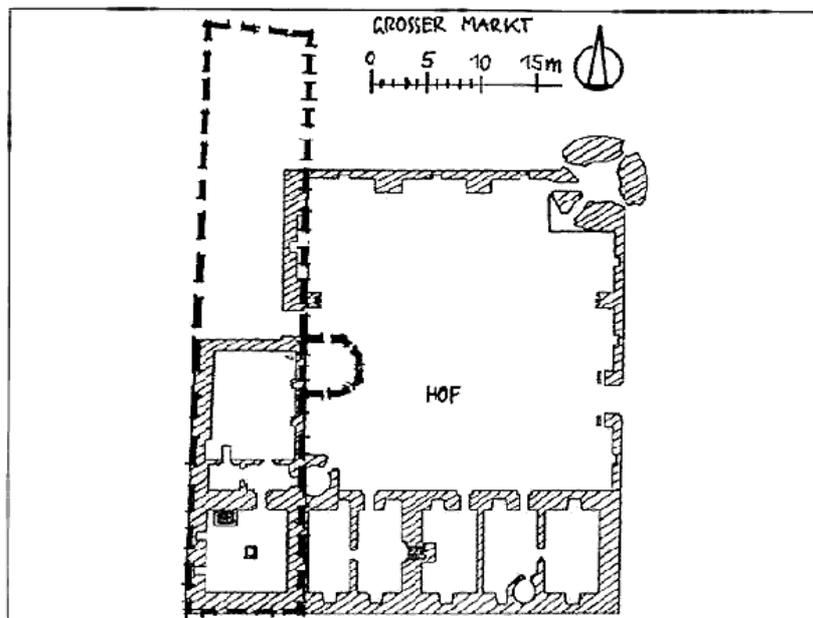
Grundrisskizze der Burganlage von 1341 (Rekonstruktion von Otto Leyse) mit vom Verfasser eingestrichelter Lage der Johannbaues
